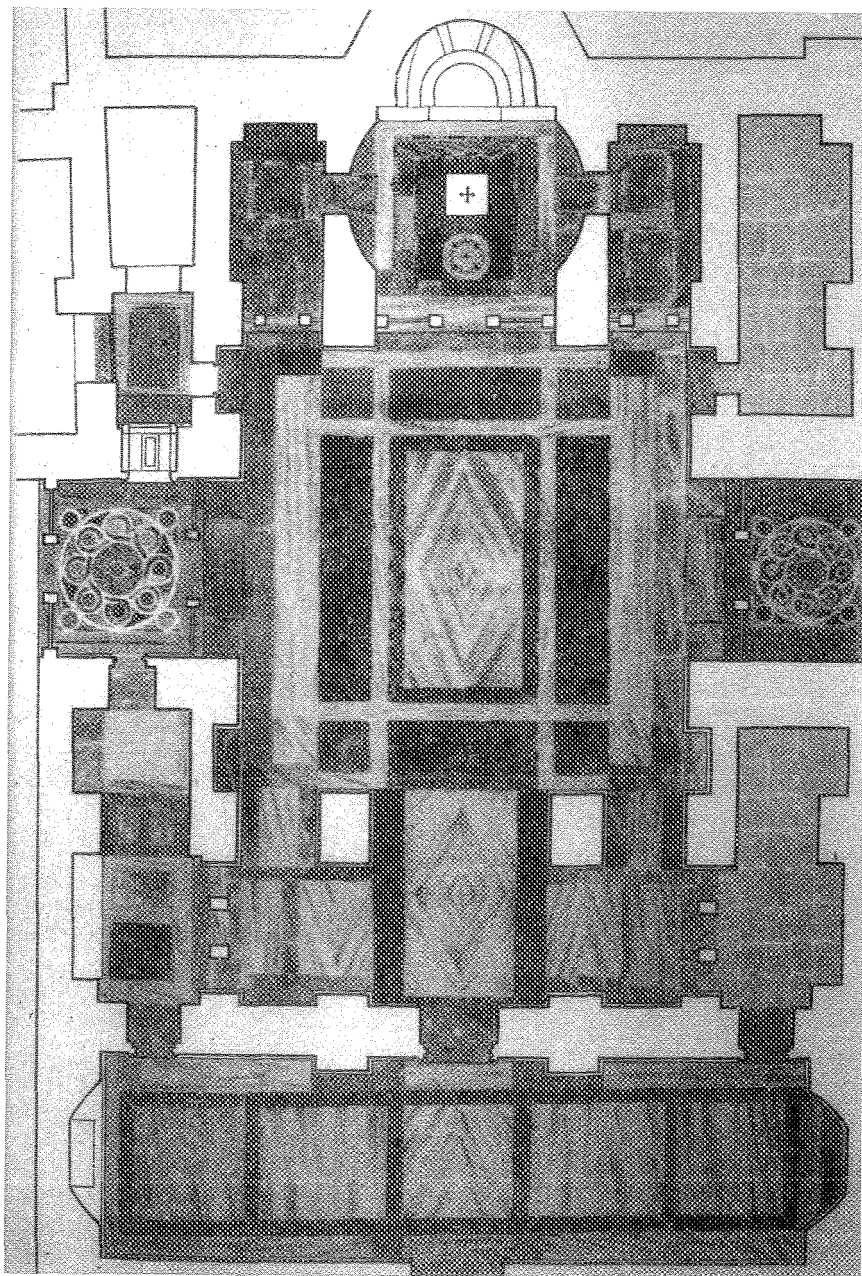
Hosios Lukas, *katholikòn*: pianta del pavimento
